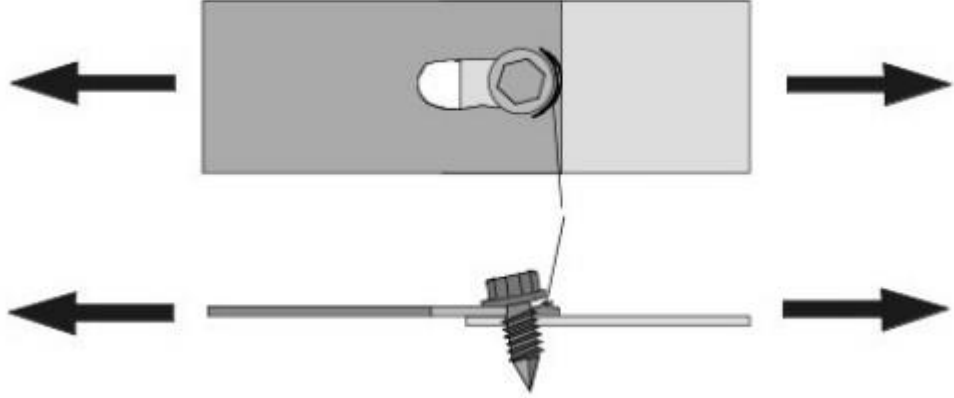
a) Birleşim elemanı önünde malzemenin yığılması b) Vida yuvasının uzaması (TC 7 - TWG 7.10 , 2009)
